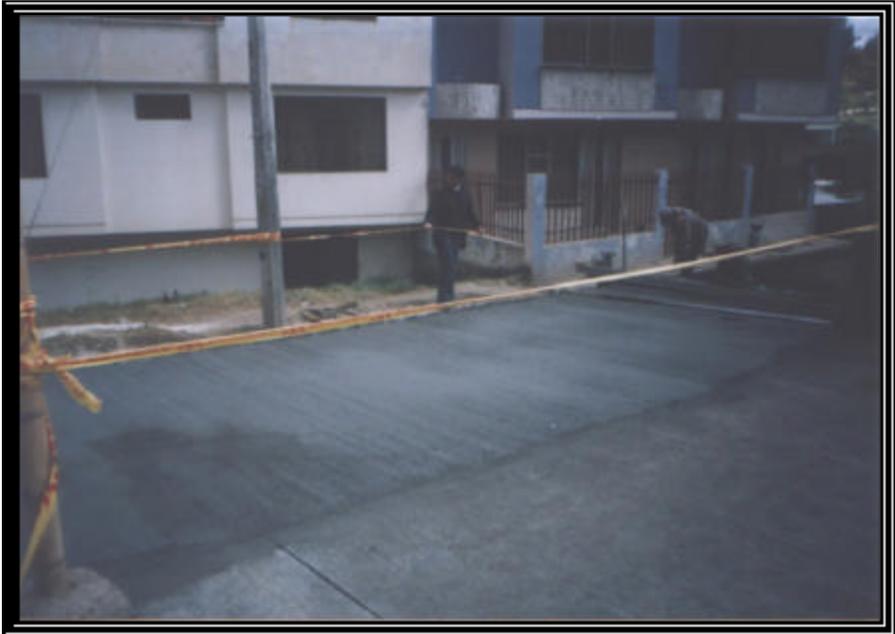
CORTE DE JUNTAS TRANSVERSALES
